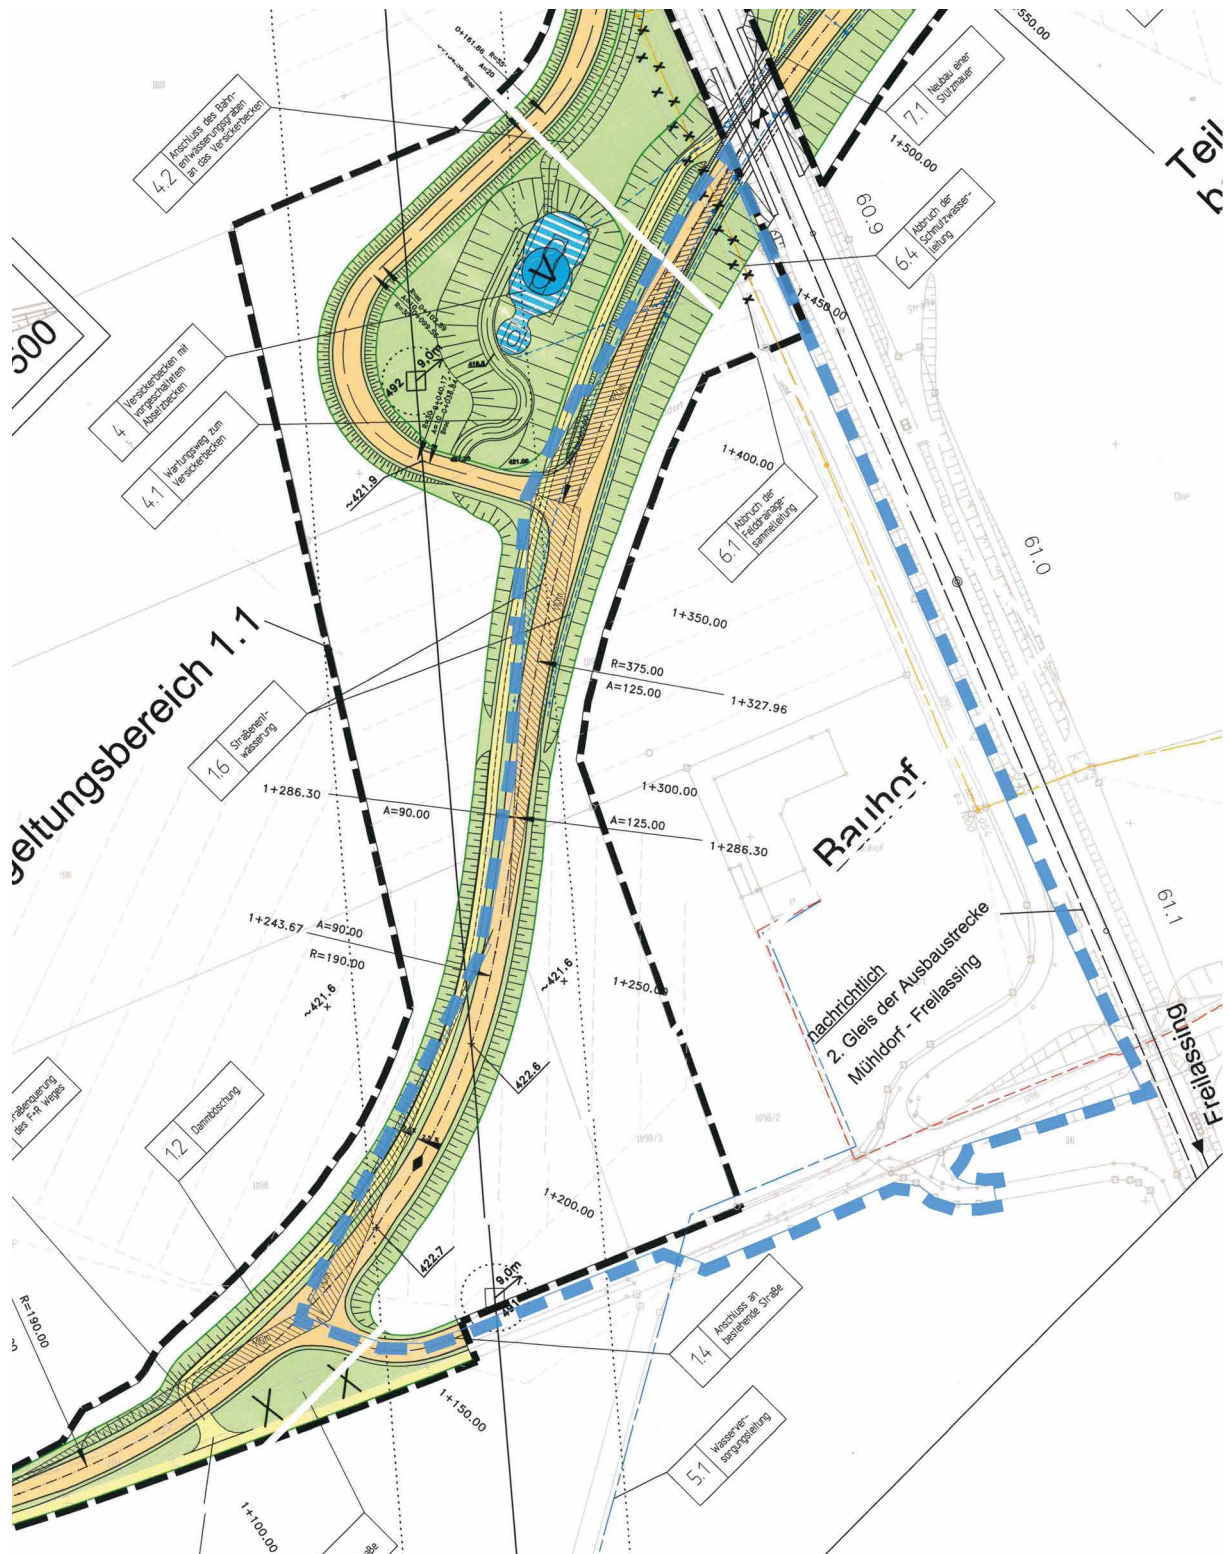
Überlagerung des Bebauungsplans „Ortsumgehung Obersurheim“ mit dem geplanten Geltungsbereich M 1:2.000 N^o
